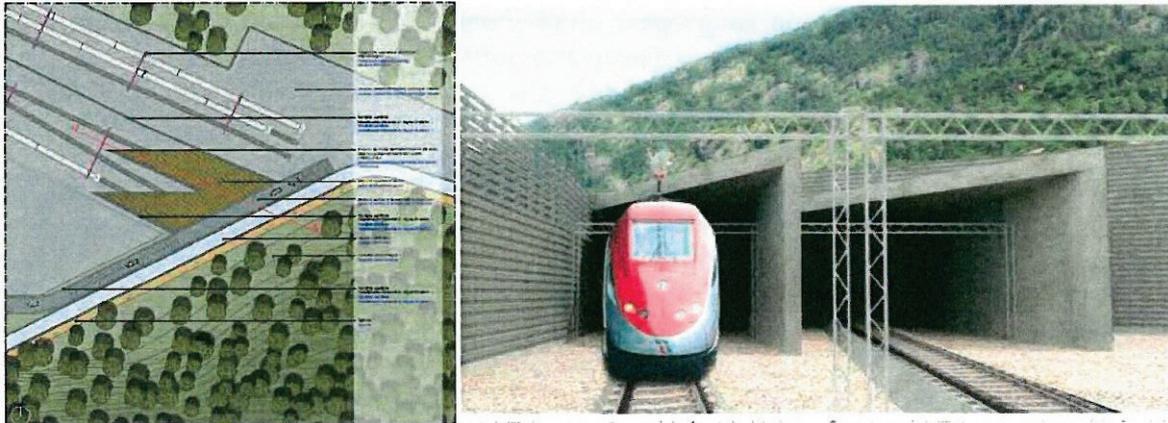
Schema planimetrico e fotoinserimento de/l'imbocco ovest dell'interconnessione (lato Susa)
